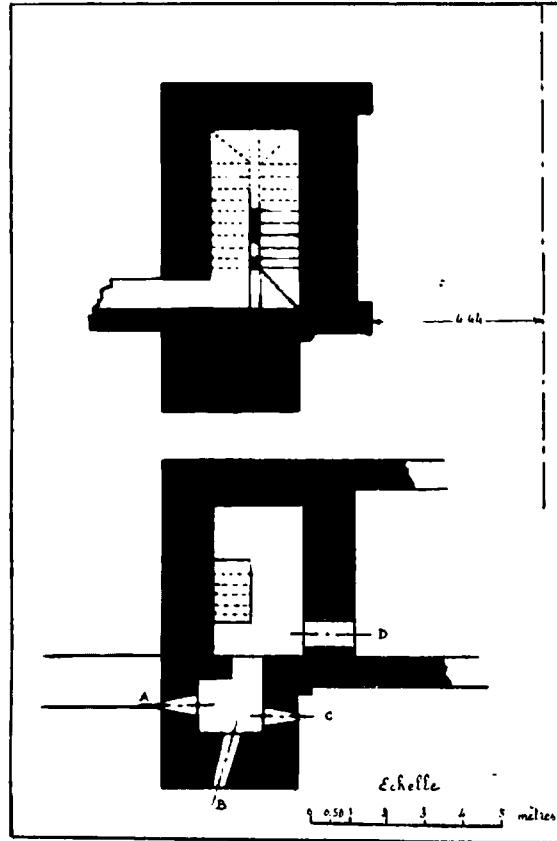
Bab el-Mrisa : en haut, plan à hauteur de l'escalier ; en bas, plan des chambres de défense.
